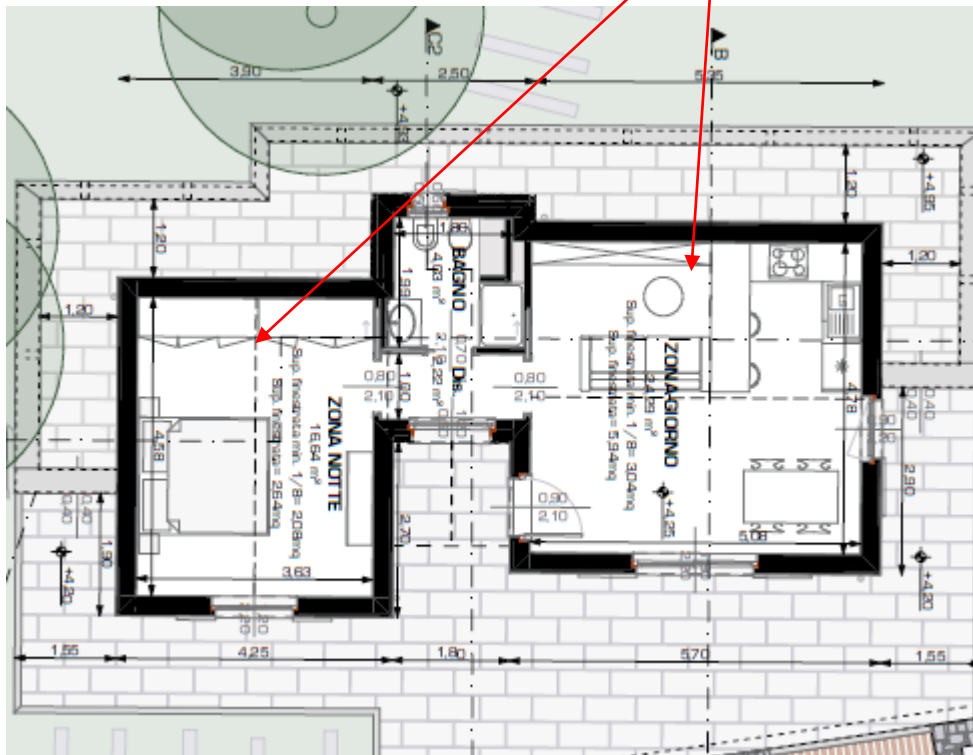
stralcio da Tavola A.2 progetto Arch Evaristi
